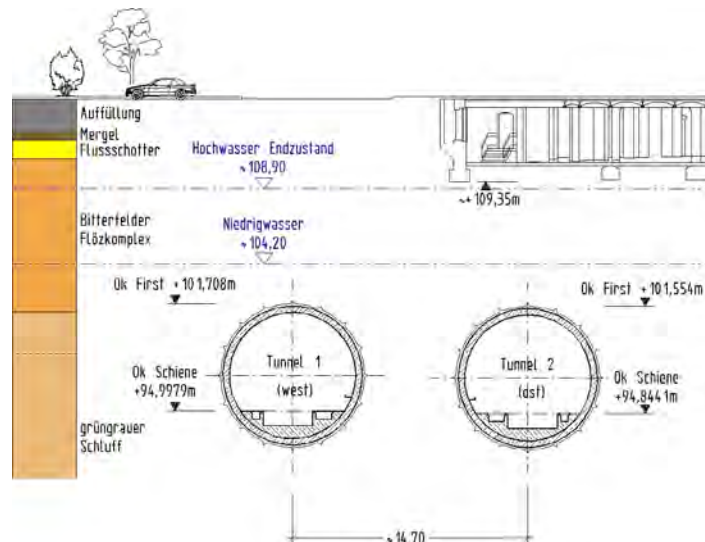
Berechnungsschnitt Alte Markthallen mit vorhandener Bebauung
